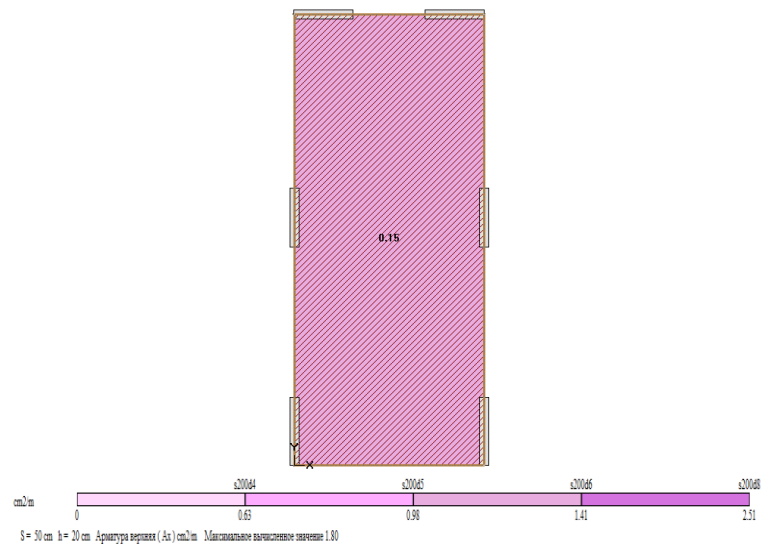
Схема ізополей та ізоліній арматури верхніх сіток плити
